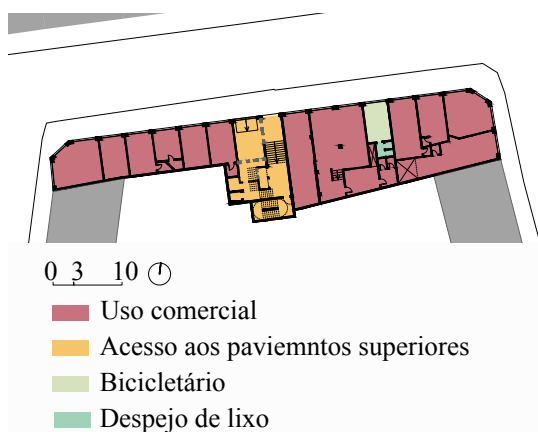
Planta proposta para o pavimento térreo com divisão de usos.
